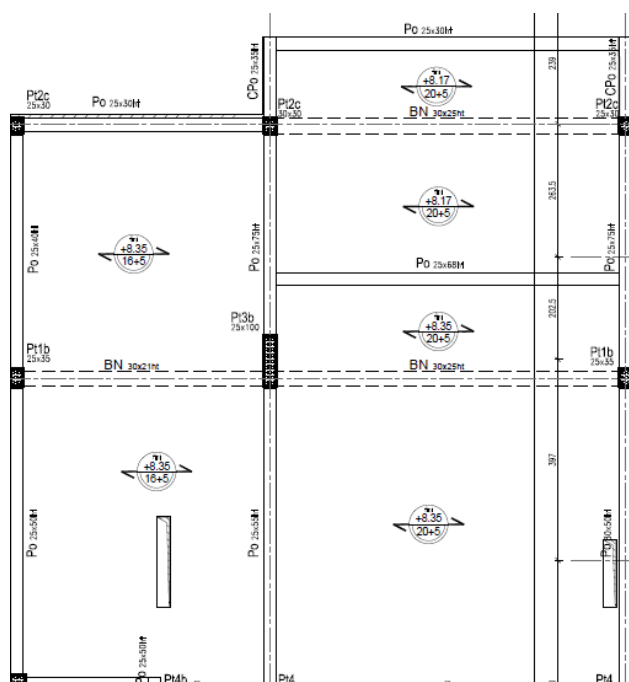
PH R+1 JOINT 23 EN POUTRELLES HOURDIS
